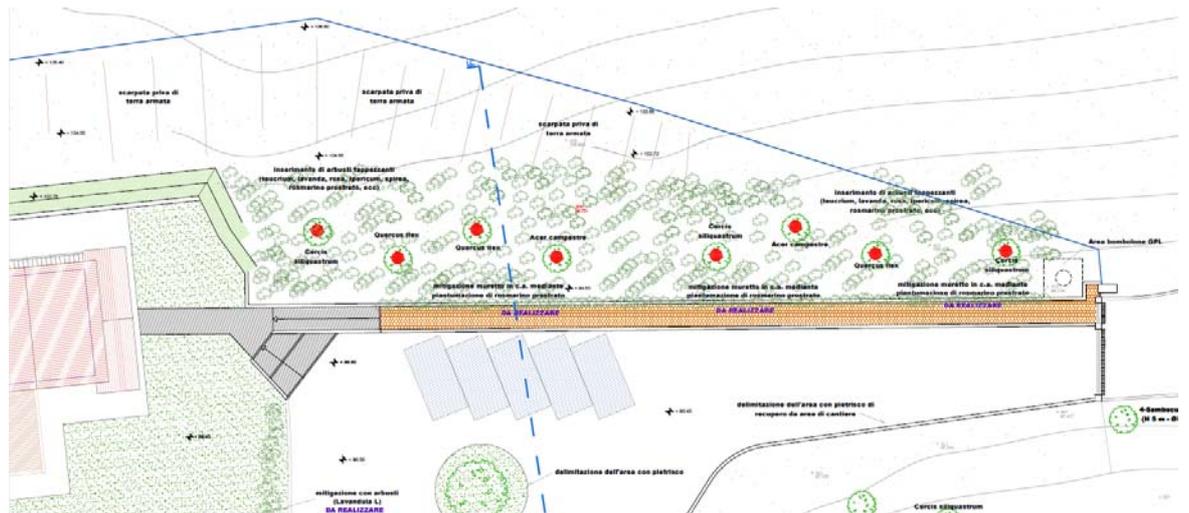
stralcio della Tav. A02 Planimetria Generale – Stato di Fatto - del gennaio 2020.
